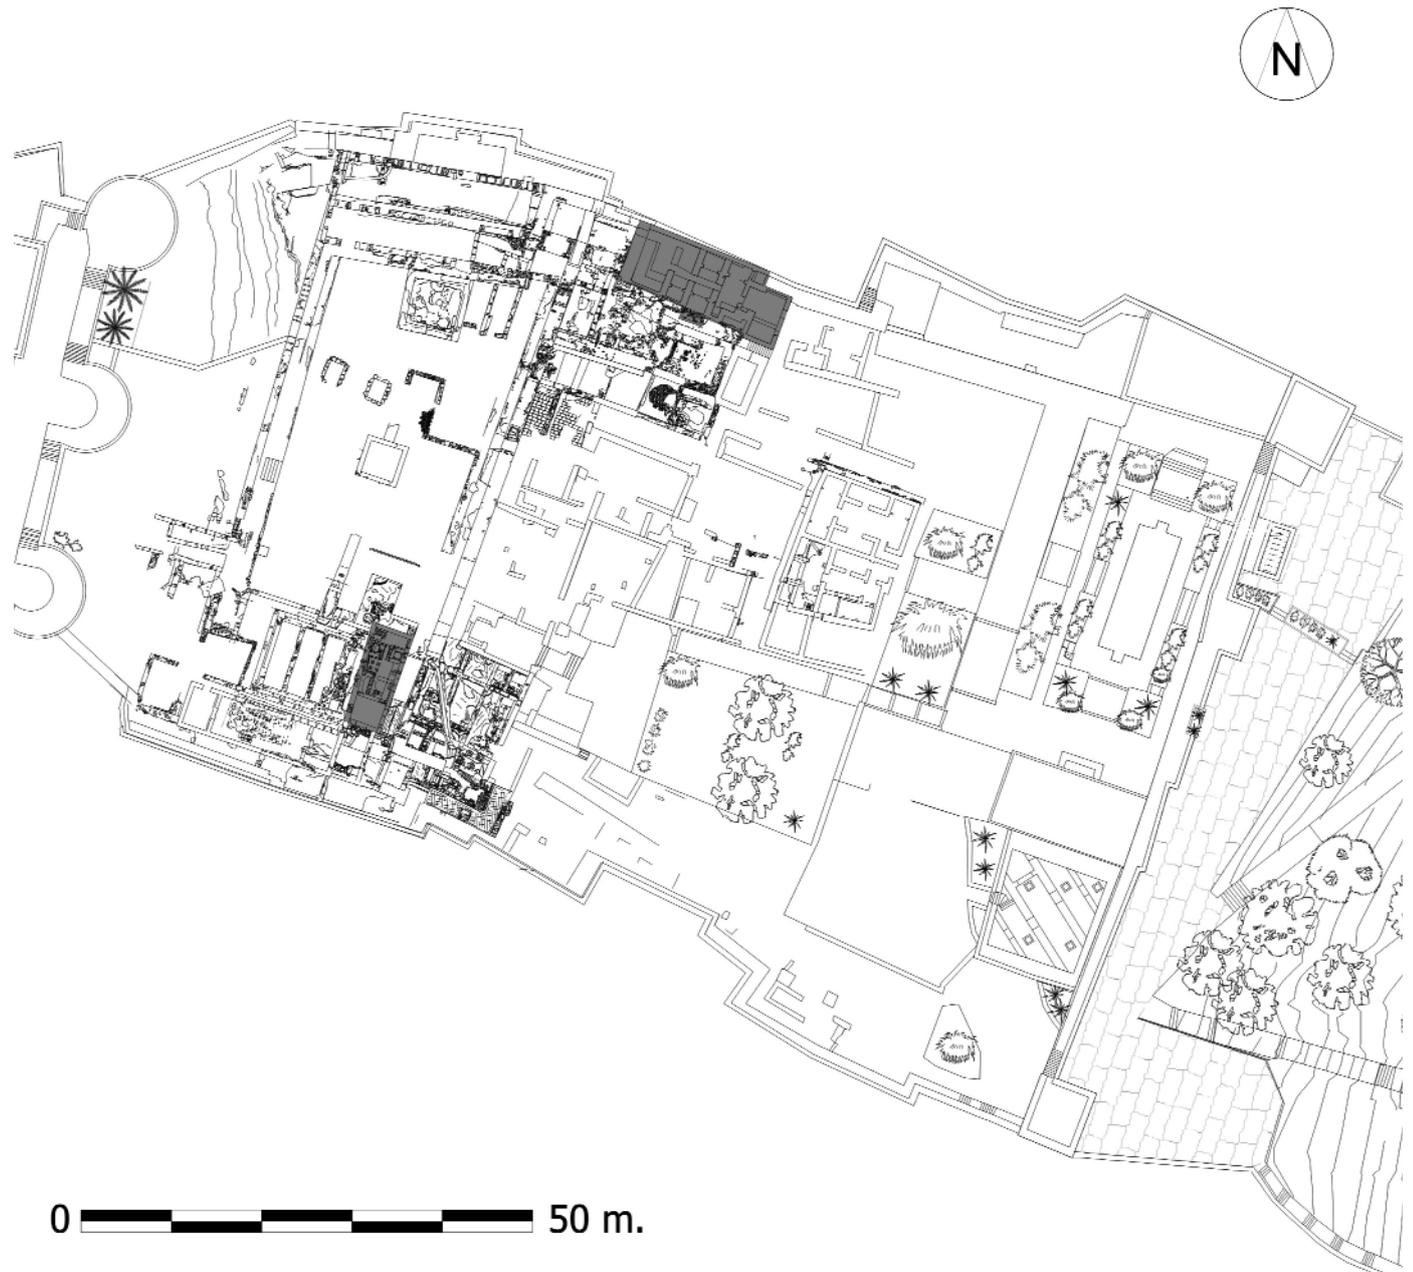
Planta general del segundo recinto de la Alcazaba de Almería indicando en gris el baño de la Reina al sur y el de la Tropa al norte.
